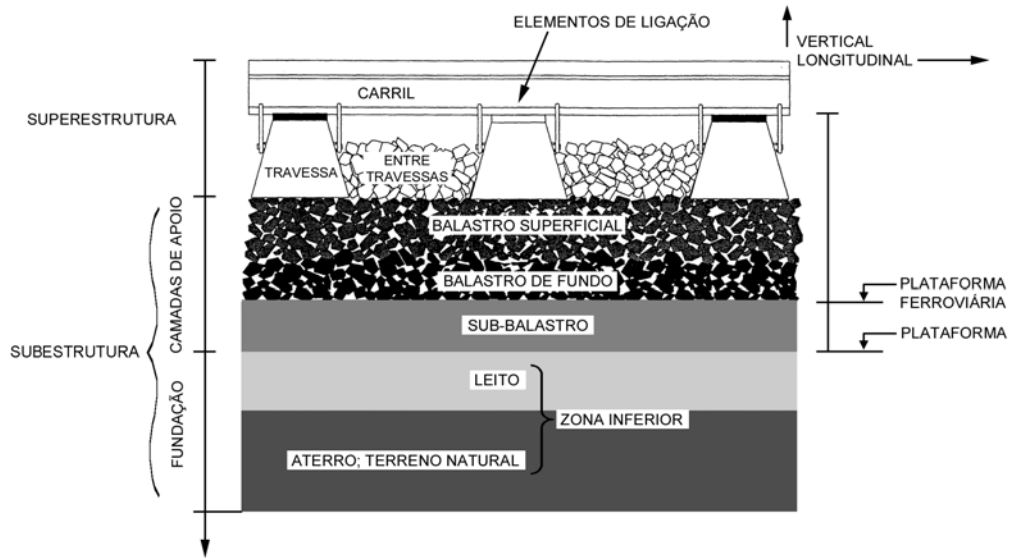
Esquema estrutural em perfil longitudinal da via balastrada (Fortunato, 2005)
